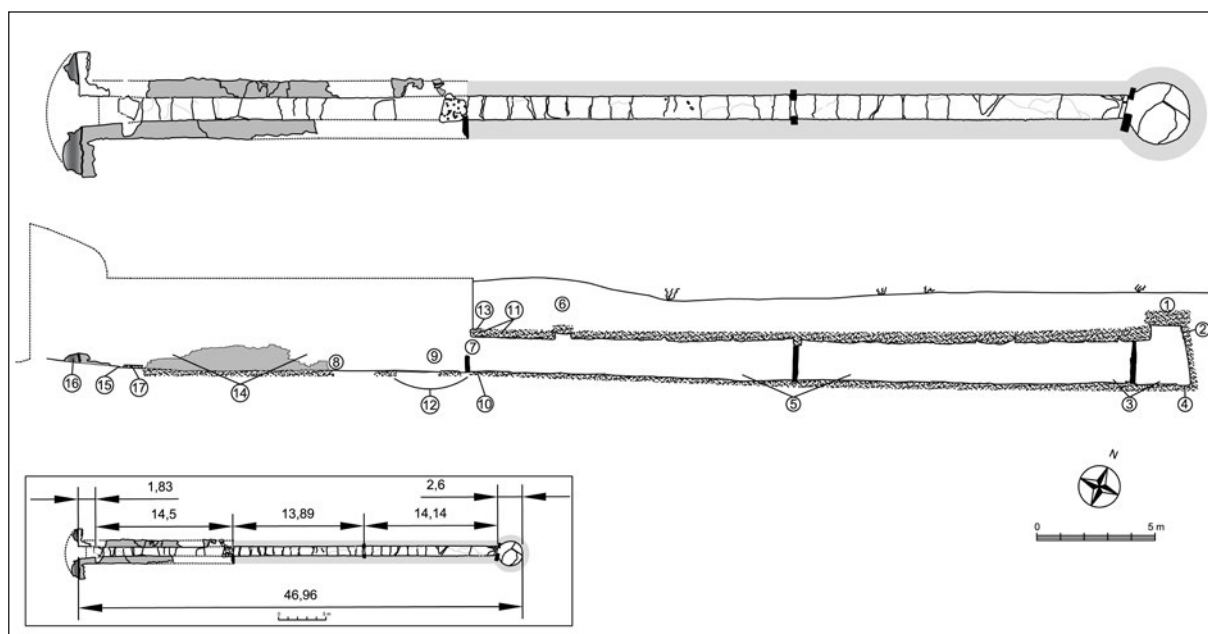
Planta y sección de La Pastora sobre la base de su escaneo (TLS) interior y exterior. En planta, las líneas claras son fracturas detectadas en las losas del suelo. En sección, localización de referencias arqueo-estratigráficas recogidas por las fuentes. Recuadro inferior con longitud general y por tramos de la construcción.
